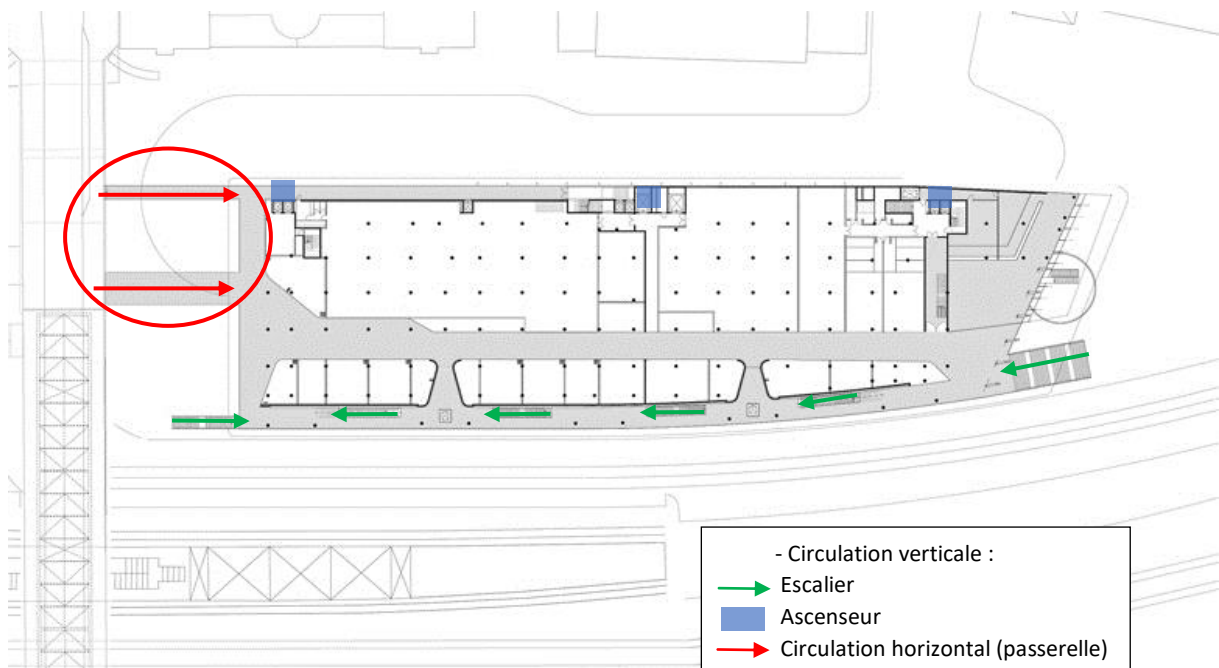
Plan du 1^{er} étage de la gare ZOB
